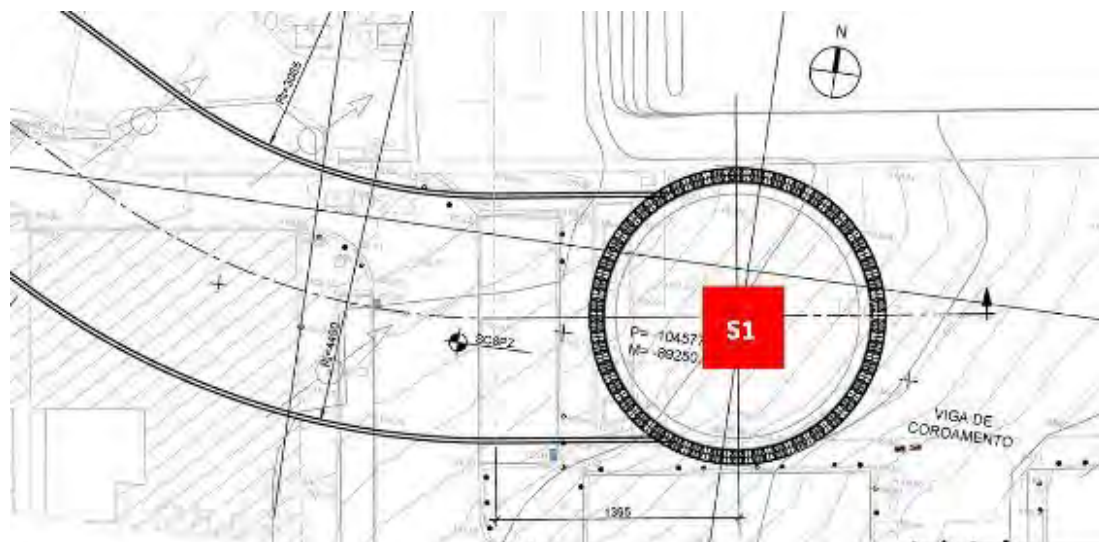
Localização da mesma sondagem sobre a planta de projeto.
